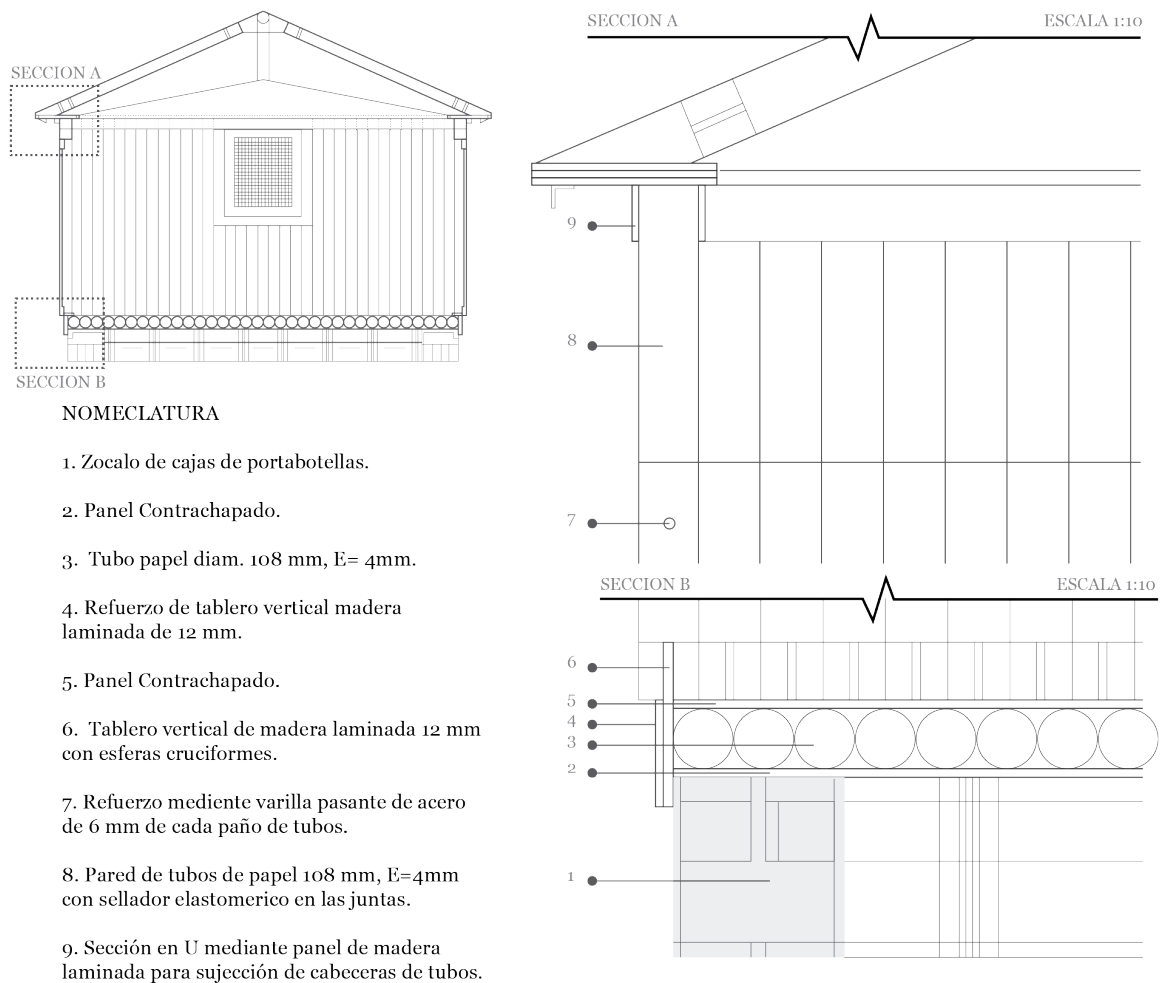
Detalle arquitectónico Paper Log House. Elaboración: Autores.
